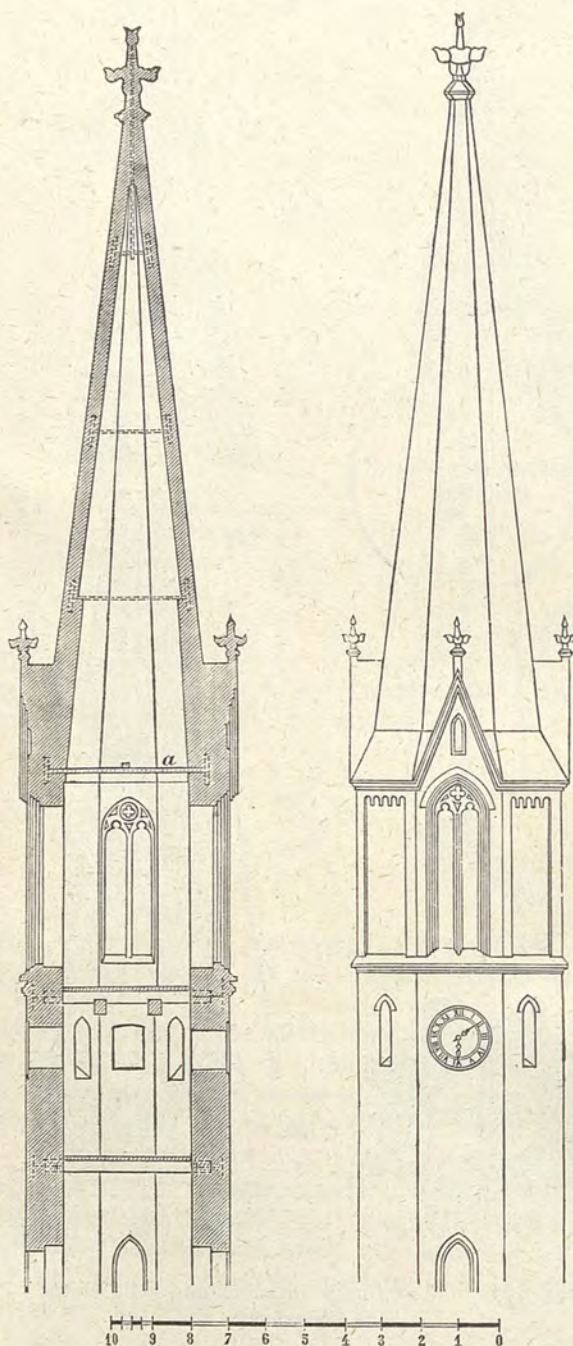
Prospetto e sezione verticale di una guglia in mattoni.
